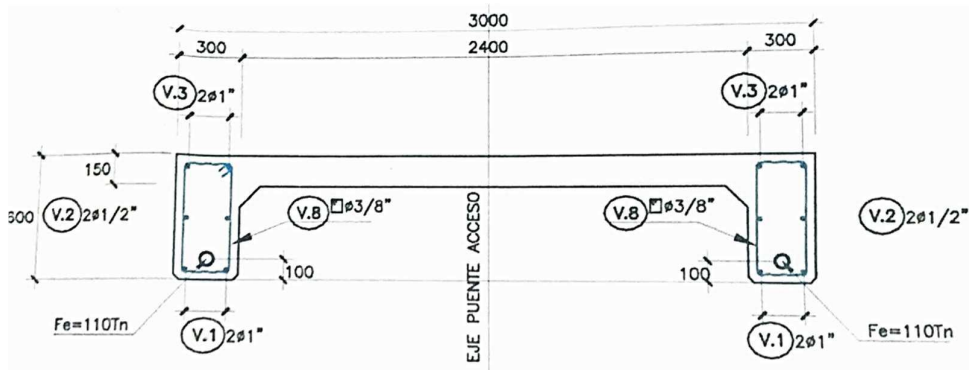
Sección transversal de la pasarela de acceso, vigas pretensadas.
